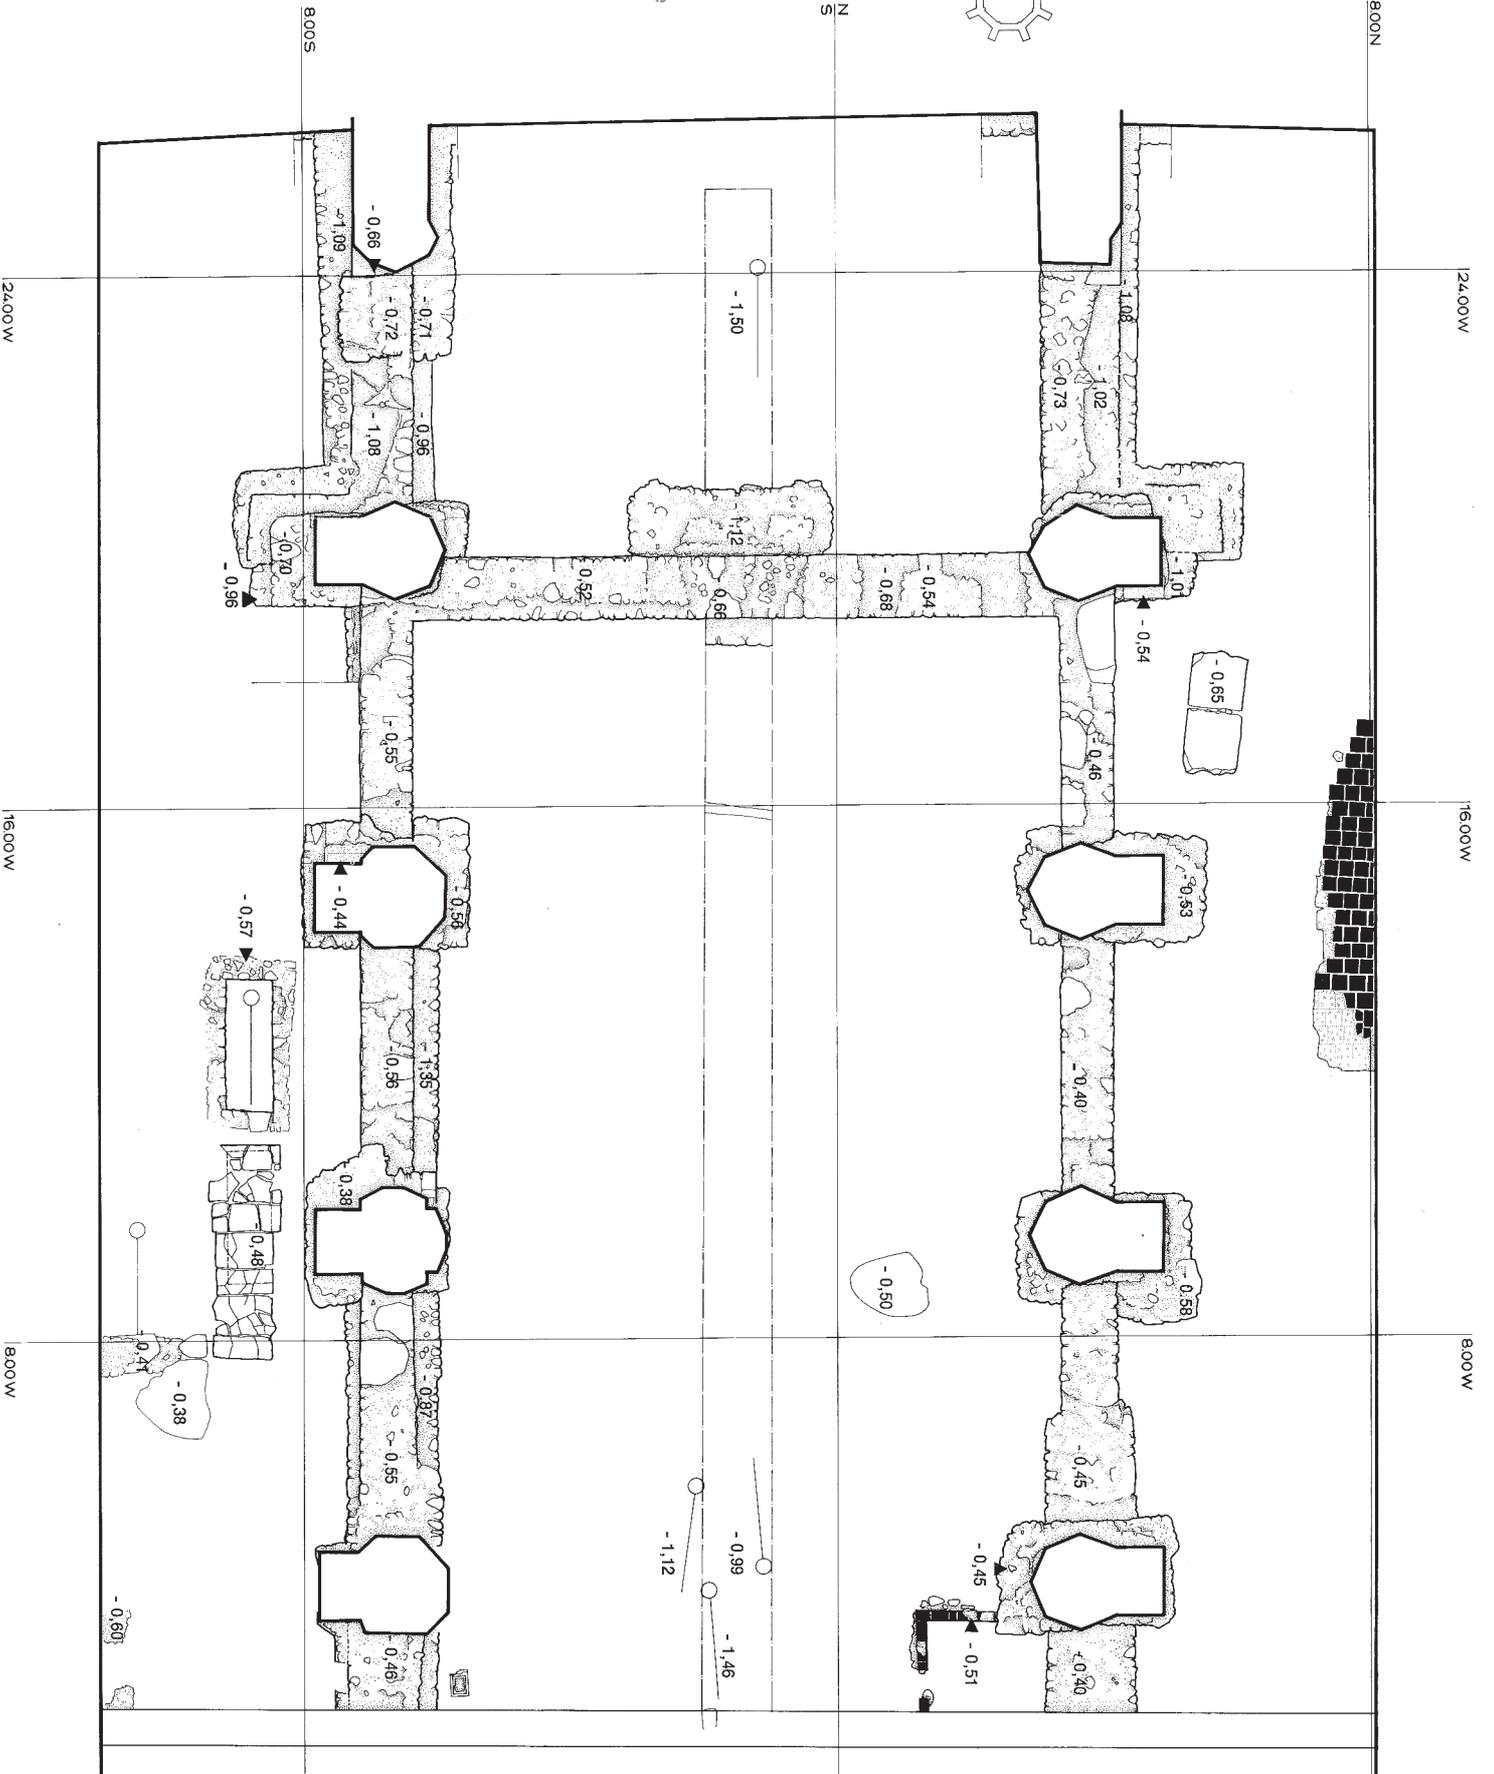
Zug, Kirche St. Oswald. Plan der archäologischen Untersuchungen im Langhaus von 1962, originaler Masstab 1:100.
